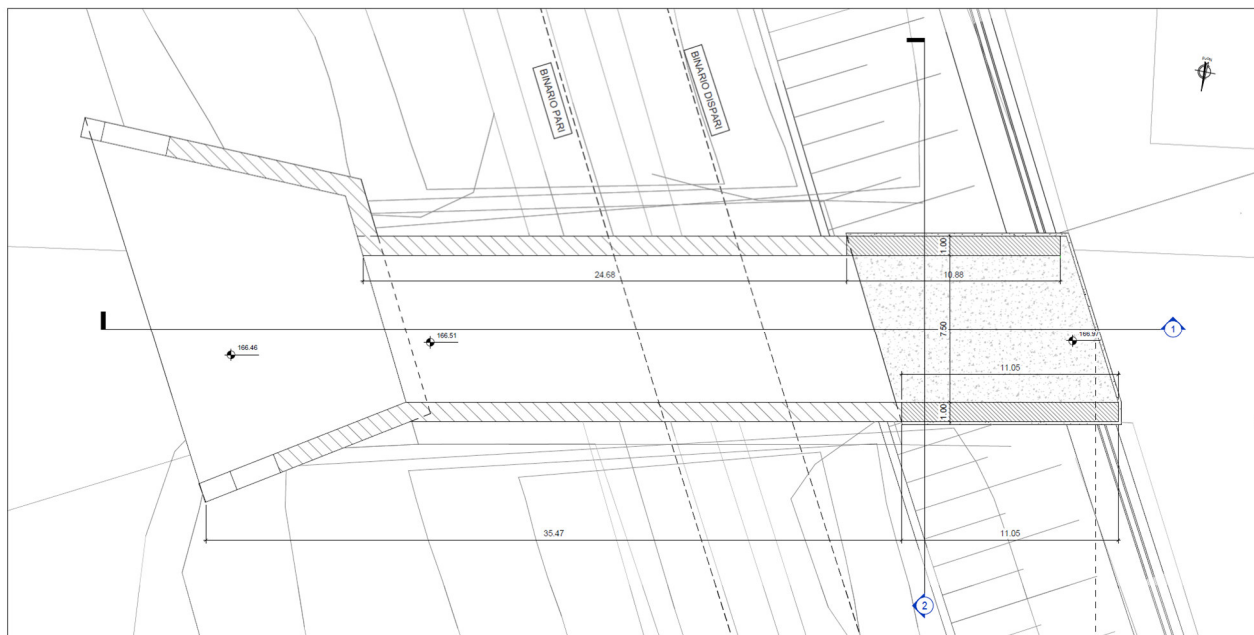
Planimetria d'inquadramento sottovia SL02
